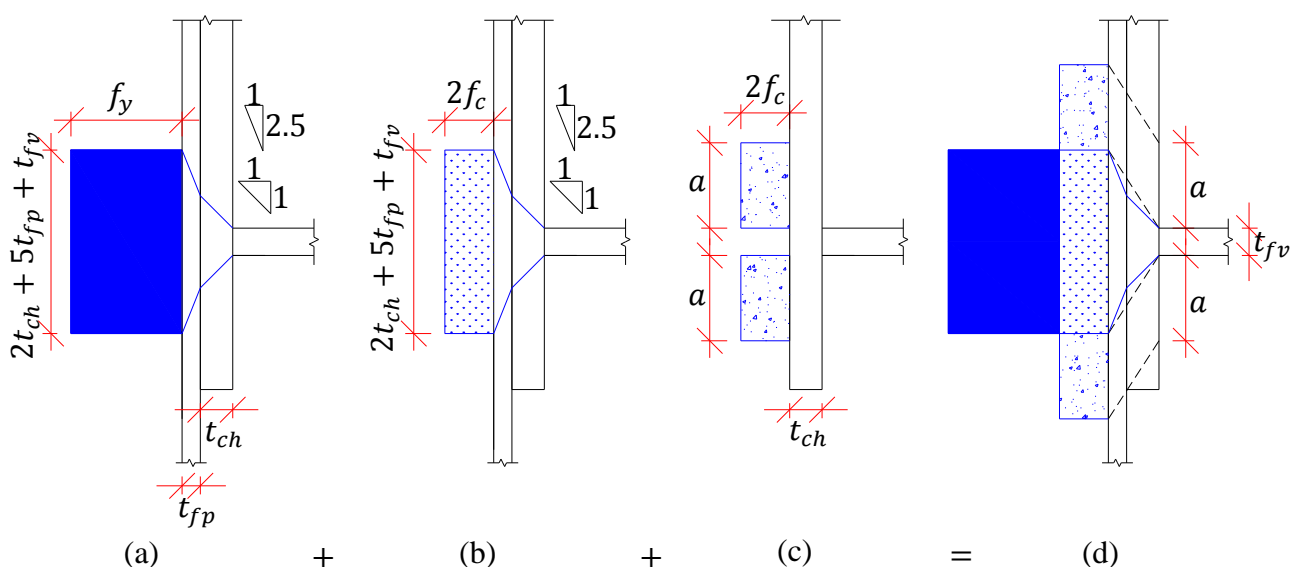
Escoamento local da alma do pilar metálico e blocos de esmagamento do concreto associados à mesa comprimida da viga
